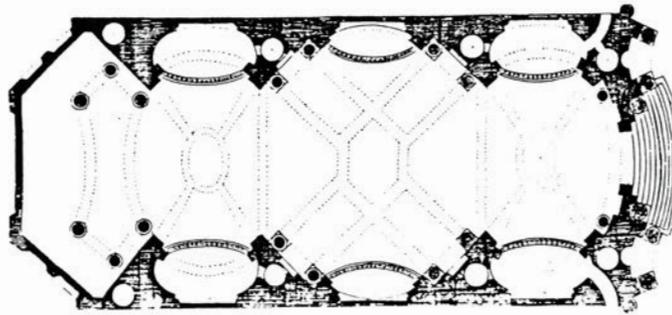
Planta de Sta. María Ettinga (Guarini).
